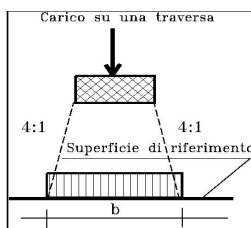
Distribuzione longitudinale dei carichi attraverso il ballast
